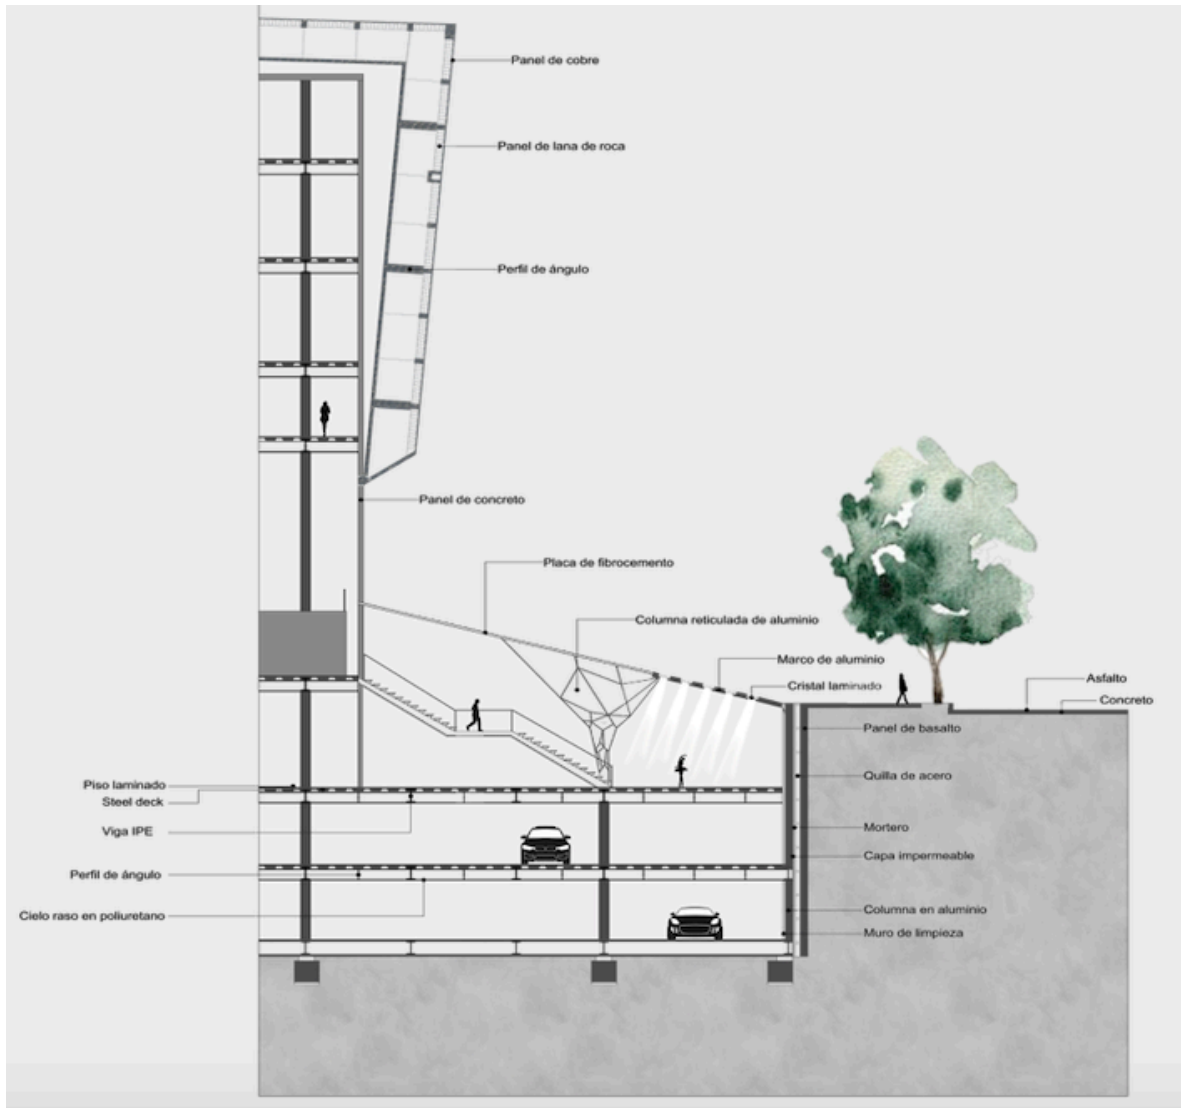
Corte fachada de zona de artistas (Elaboración propia)
